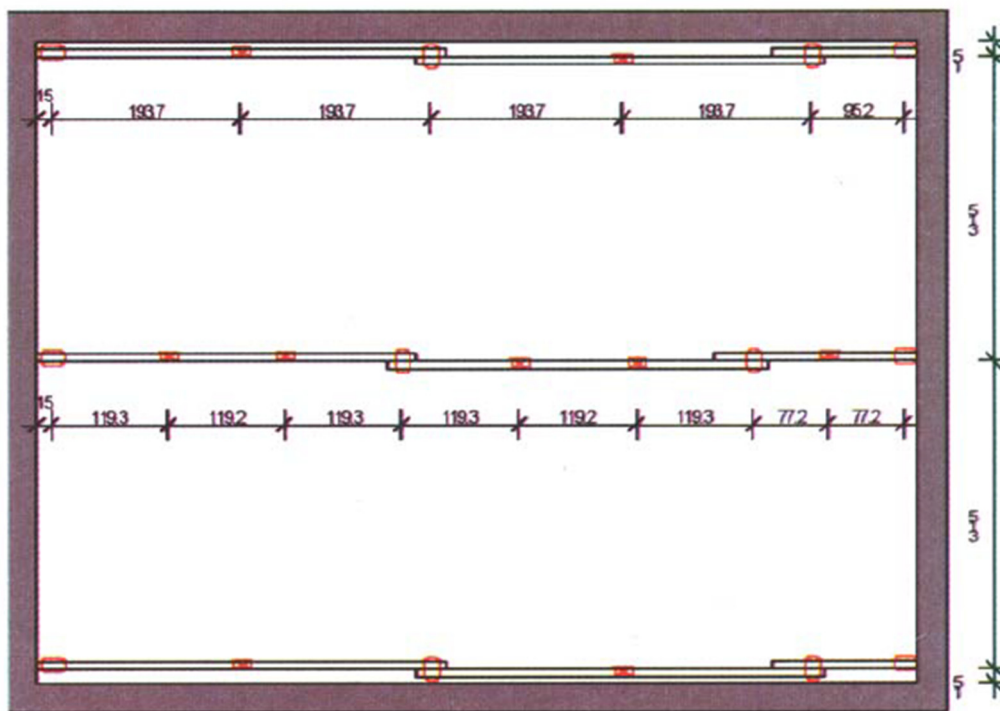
Вариант раскладки опалубки вдоль длинной стены
